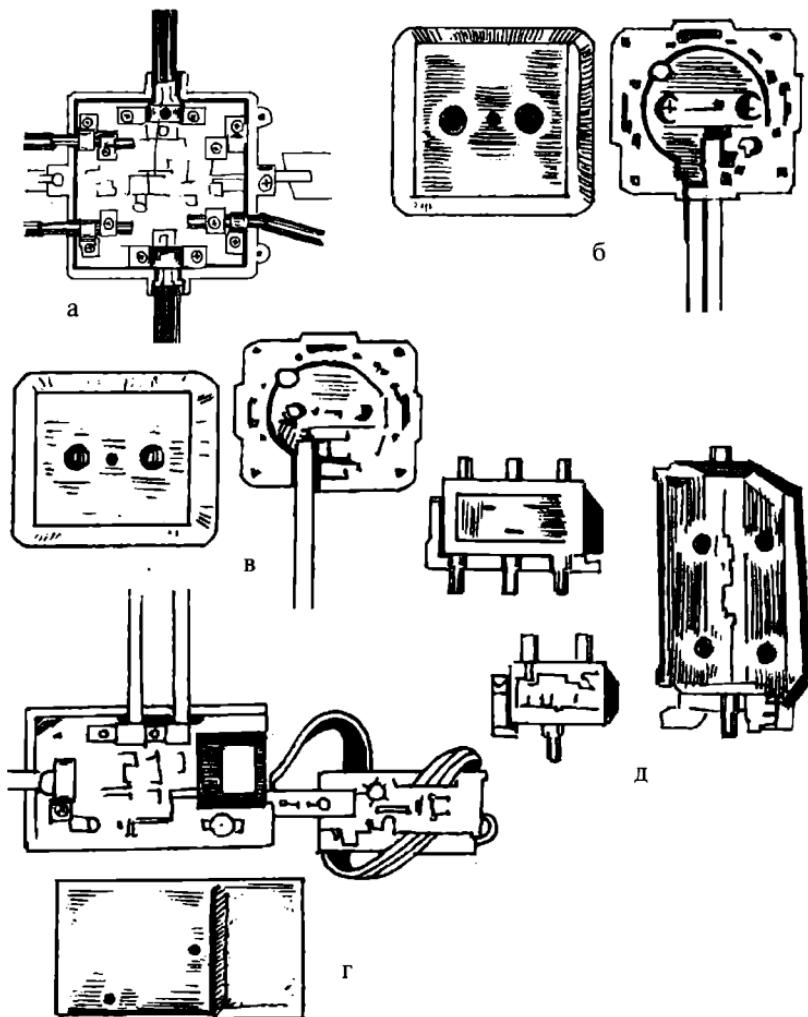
Установочная аппаратура и монтажные приспособления для прокладки телевизионной сети: а — закрепление кабеля в распределительной коробке; б — проходная телерозетка; в — конечная телерозетка; г — малогабаритный усилитель «Ikusi ATB 122»; д — внешний вид телевизионных разветвителей
